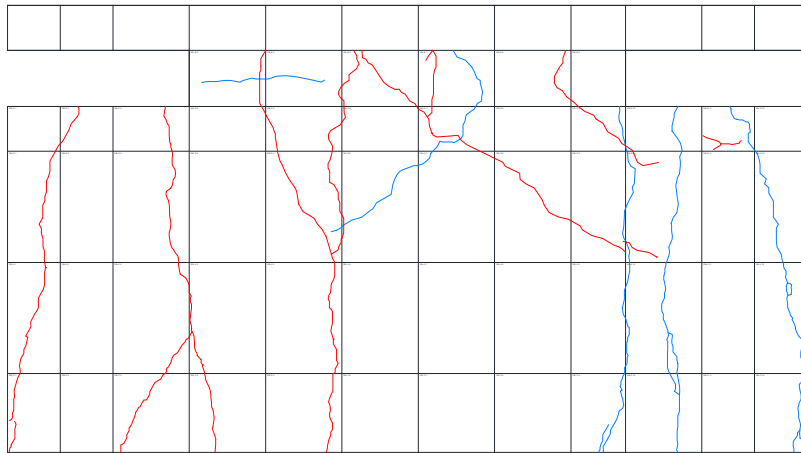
載荷終了時点のひび割れ 壁梁のひび割れ
